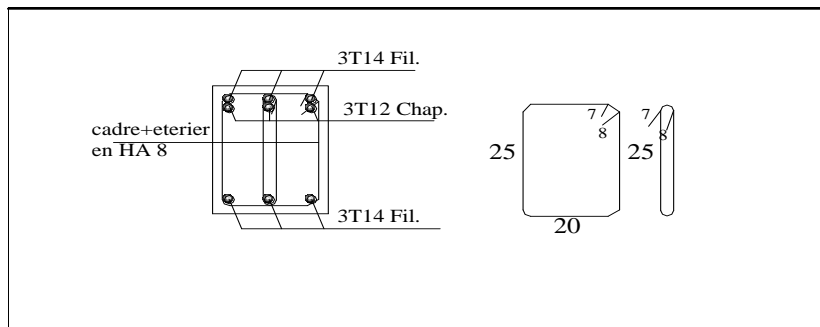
Ferrailage en travée d'une poutre secondaire PS1 et PS2 sur appuis.
